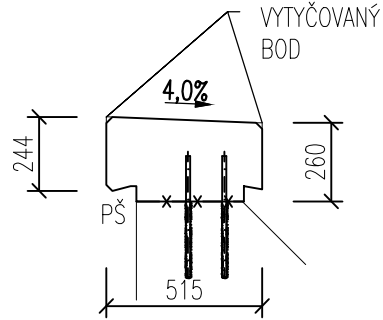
DETAIL - KOTEVNÍ PRVKY ŘÍMSY
